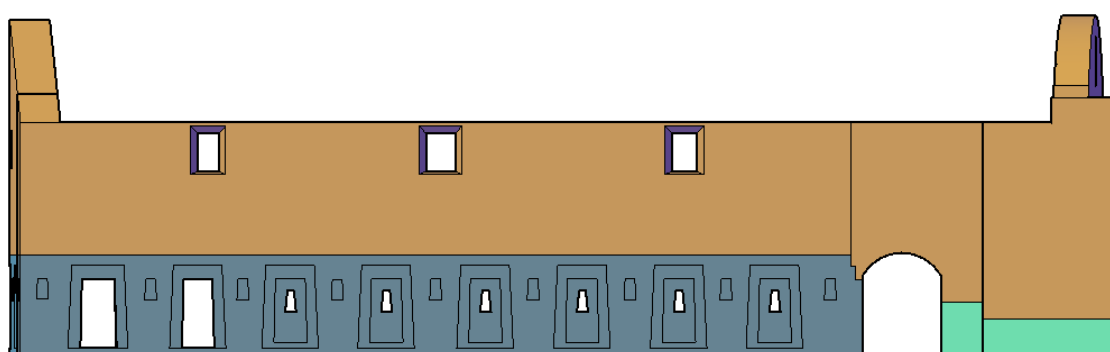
Vista exterior de muro sur de la iglesia San Juan Bautista.
